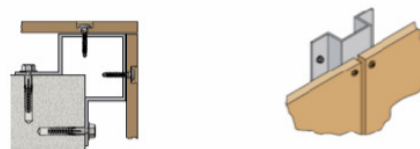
Detalhes de fixação no canto e perfil ómega. [18]
